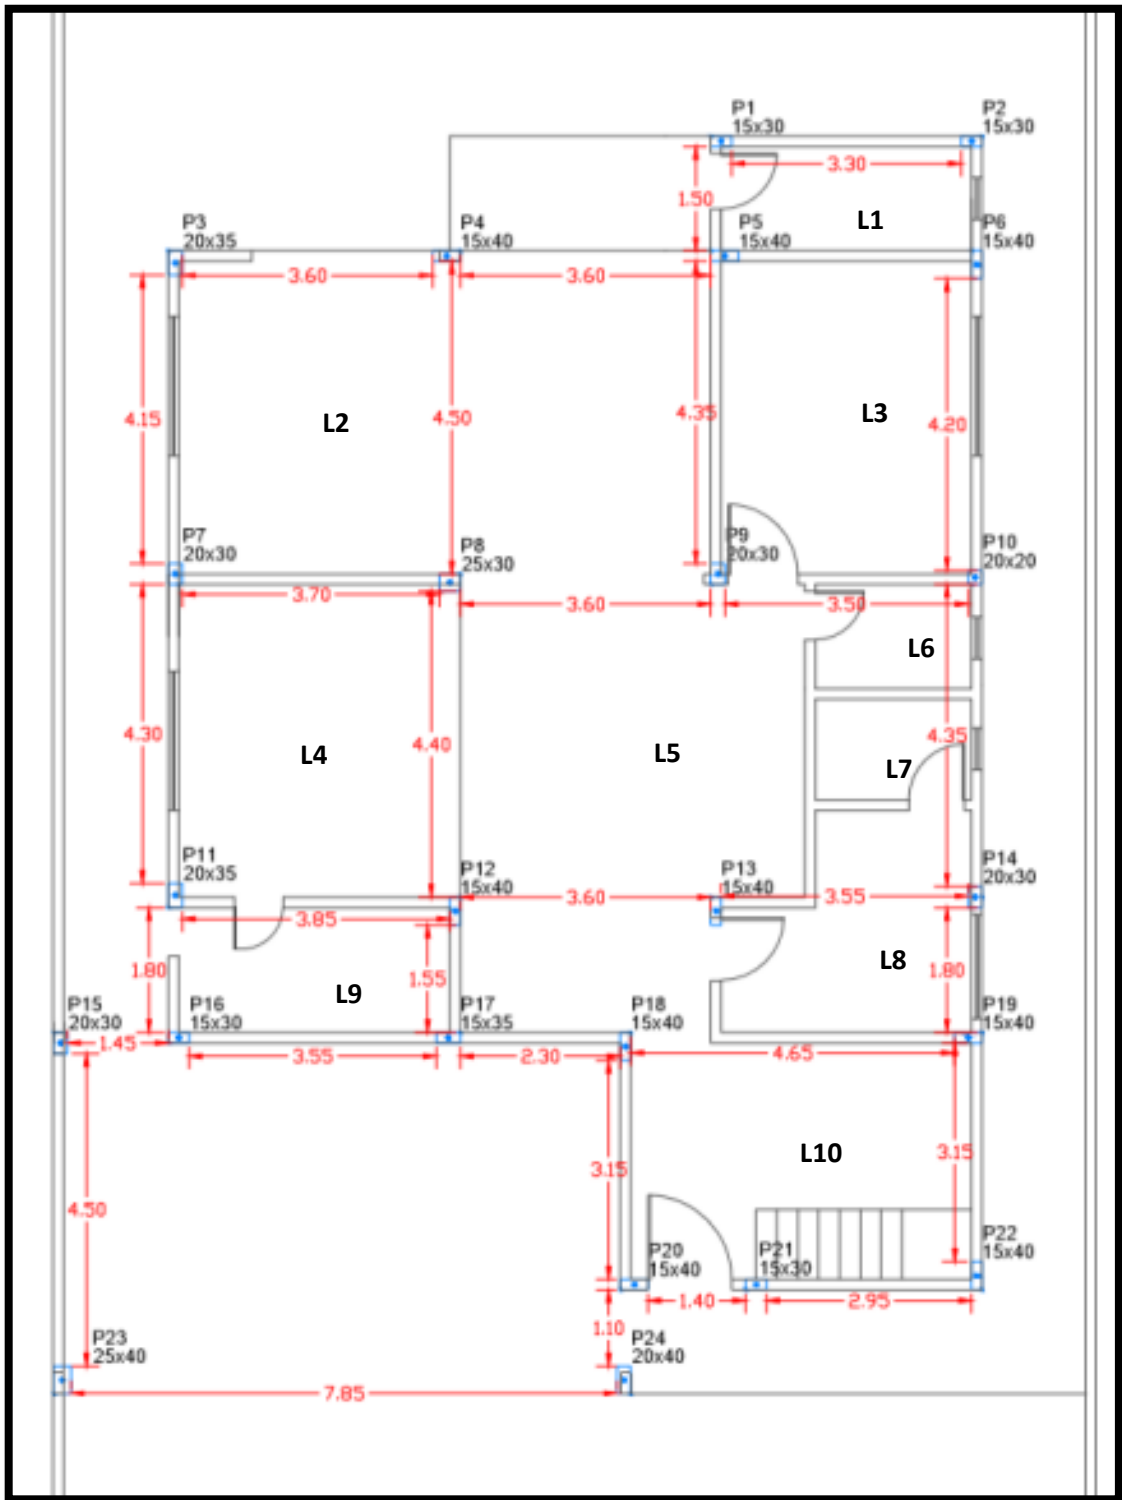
Planta 1º pavimento – medidas em Concreto Armado
